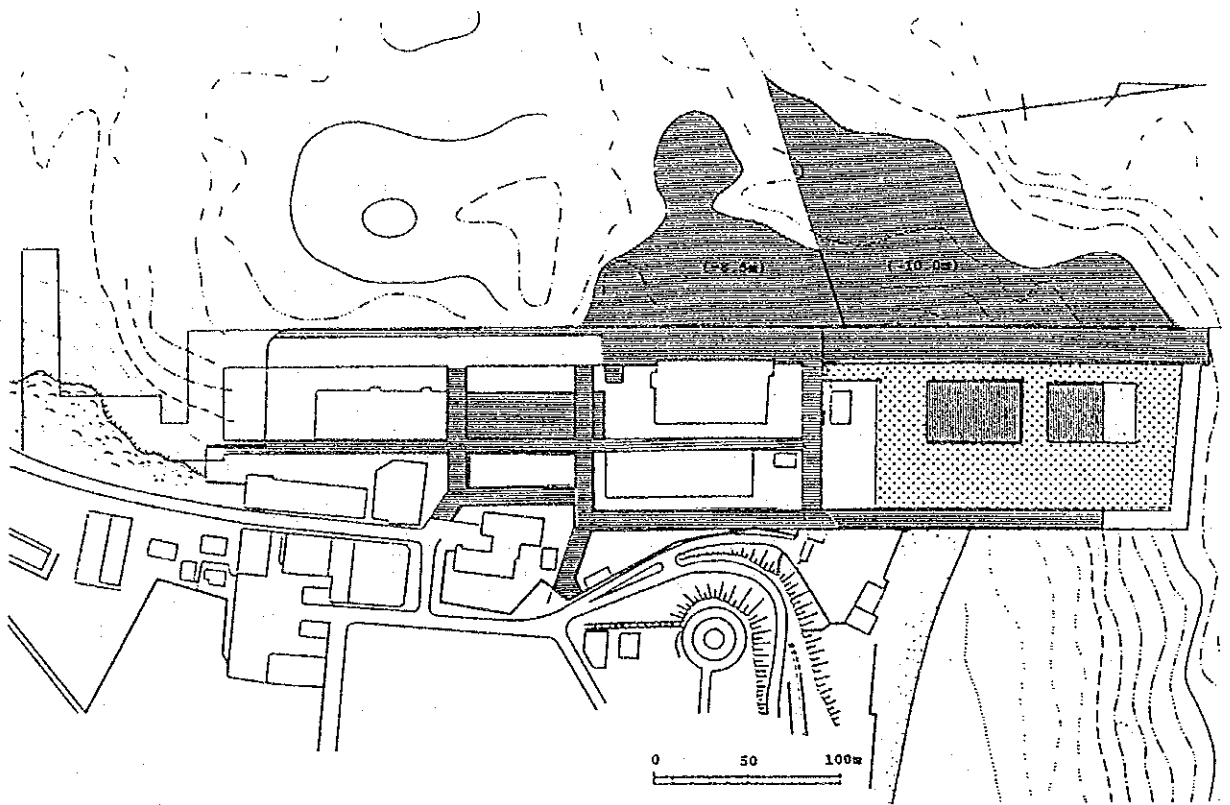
(3) Avancement des Travaux de Construction à la Fin de 1997
